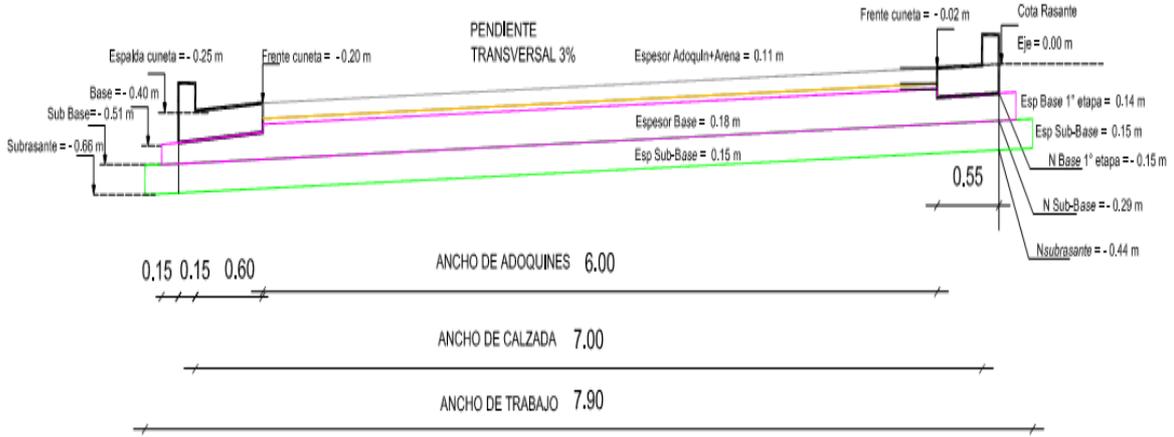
Perfil tipo de la vía del proyecto
